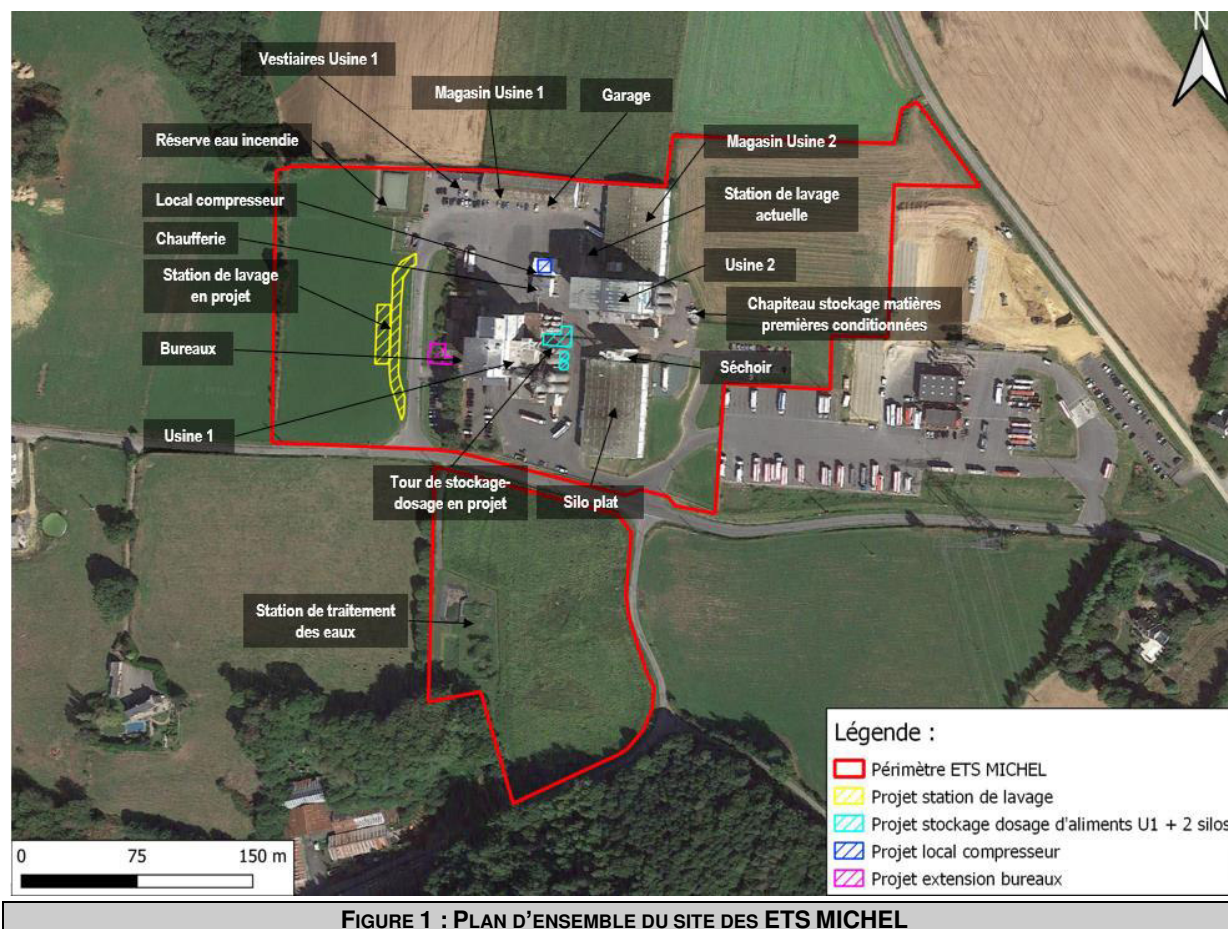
PLAN D'ENSEMBLE DU SITE DES ETS MICHEL
